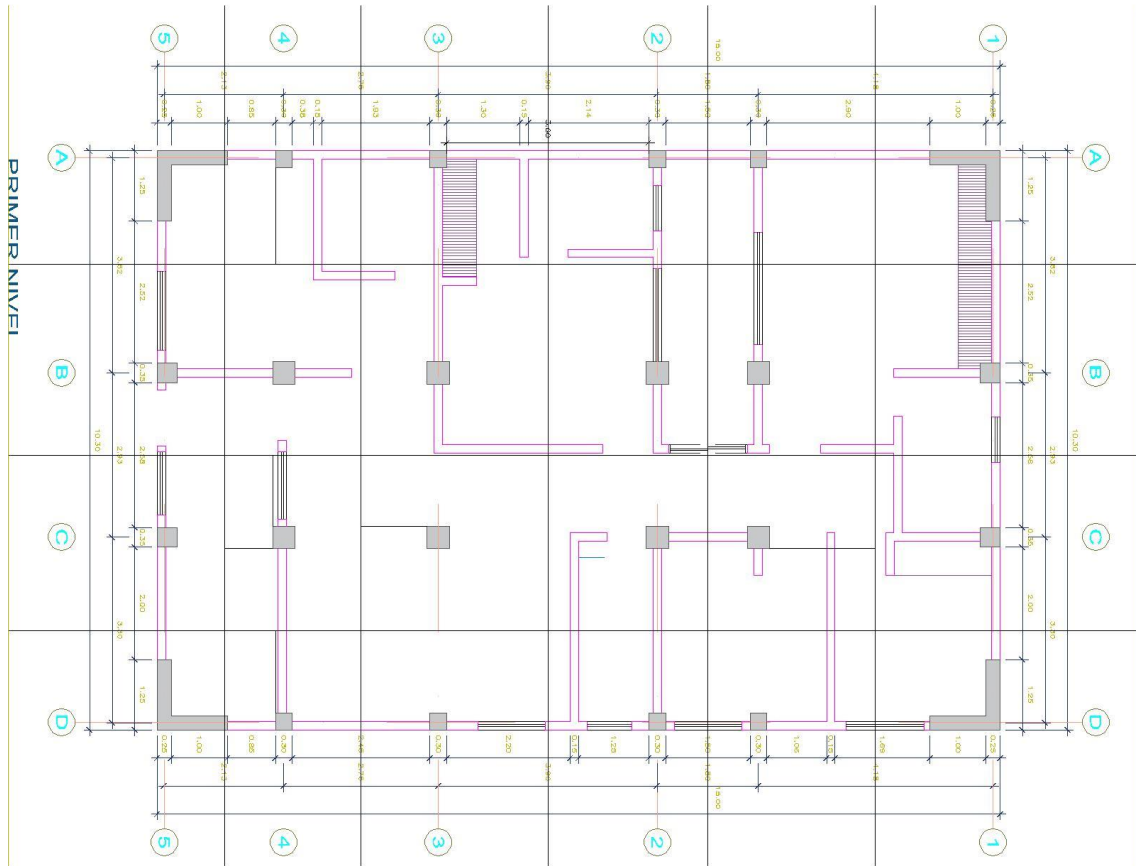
Plano de Planta - Estructuras de Edificio de 6 pisos
